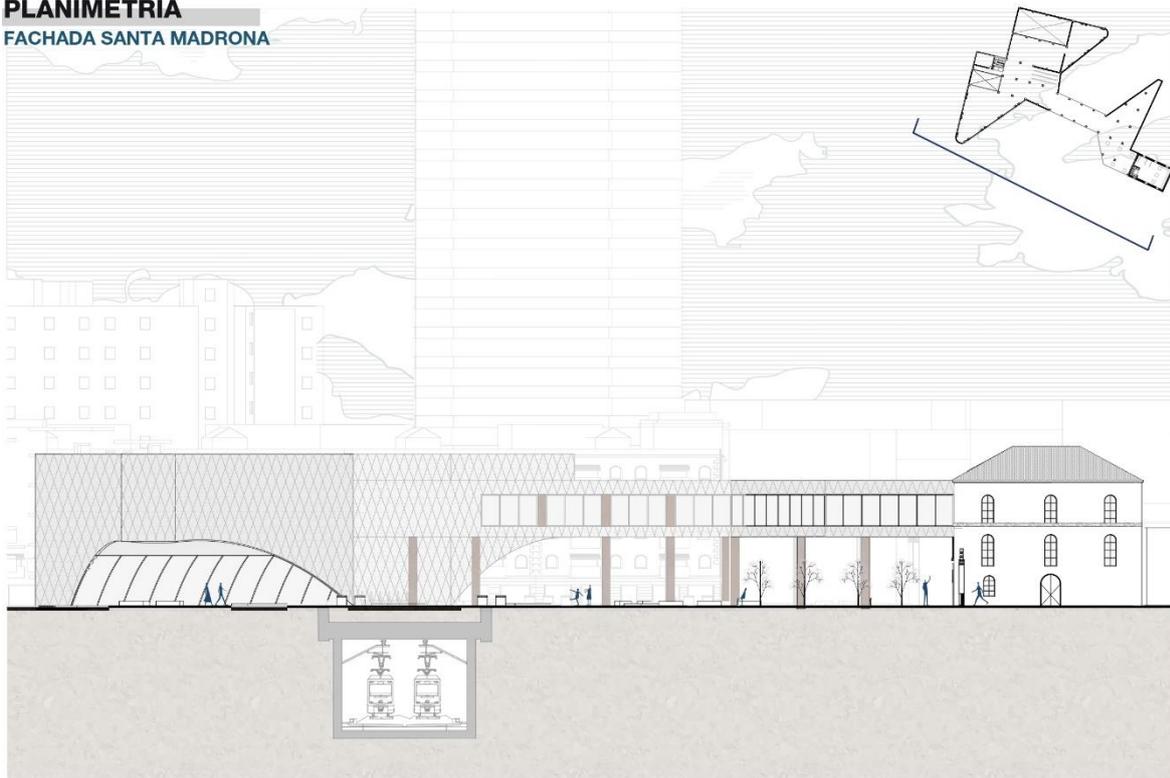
Fachada Santa Madrona (Elaborado por: David Calderón)
